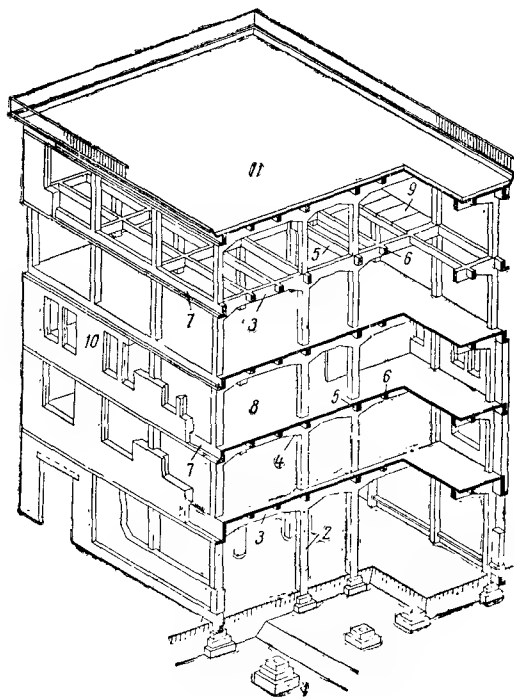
Каркасный остов из монолитного железобетона с ребристыми перекрытиями
